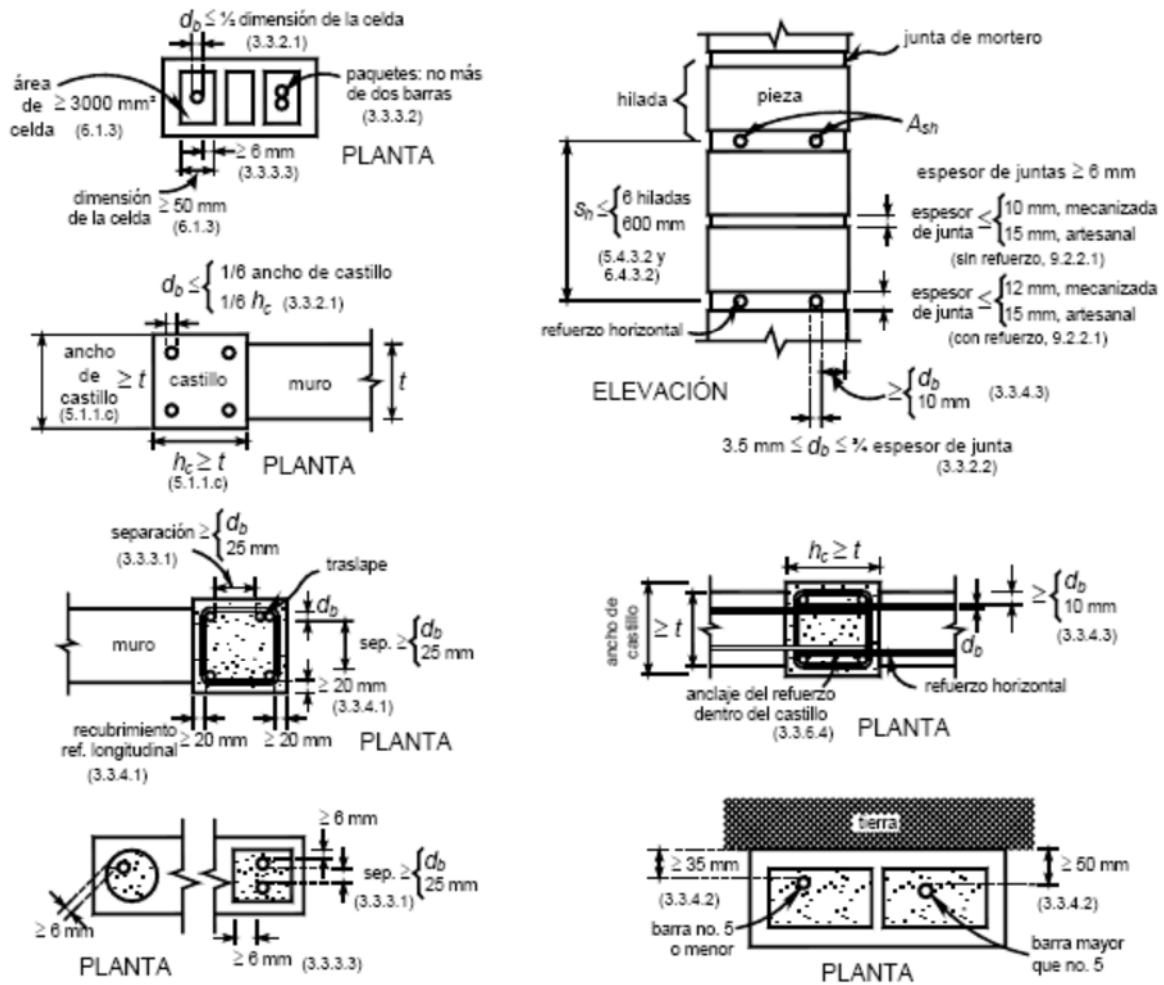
Tamaño, colocación y protección del refuerzo.
